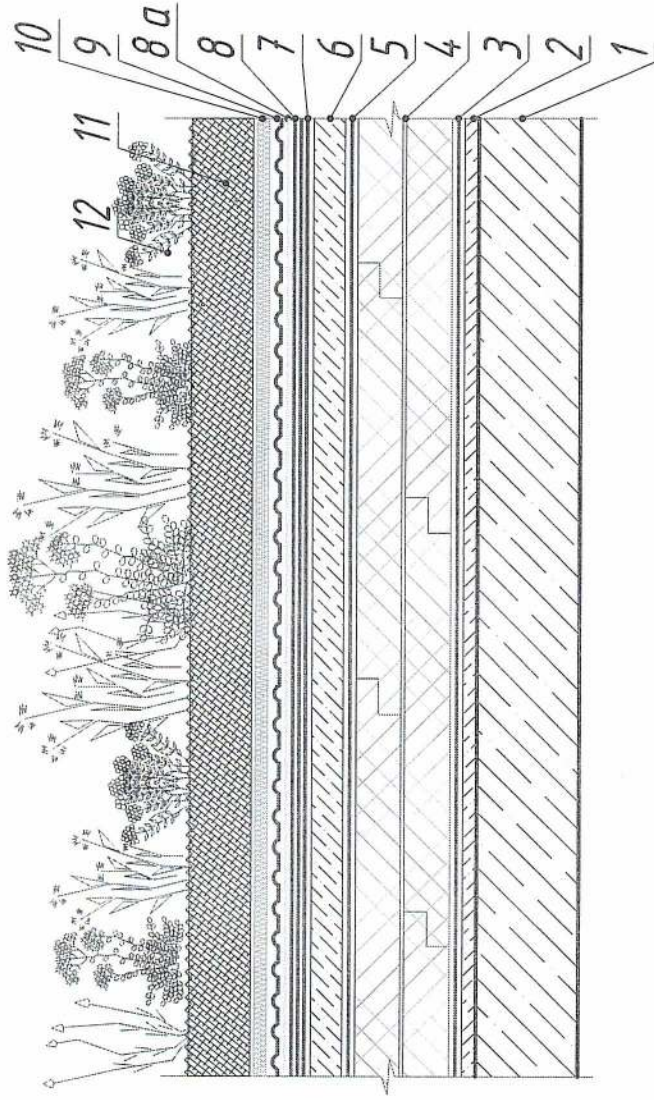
Принципиальная схема конструктивного исполнения бесчердачного покрытия выполняемого по железобетонному основанию (эксплуатируемая кровля с зелеными насаждениями)
